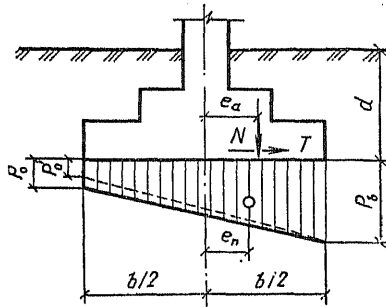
Эпюра предельного давления под подошвой фундамента
